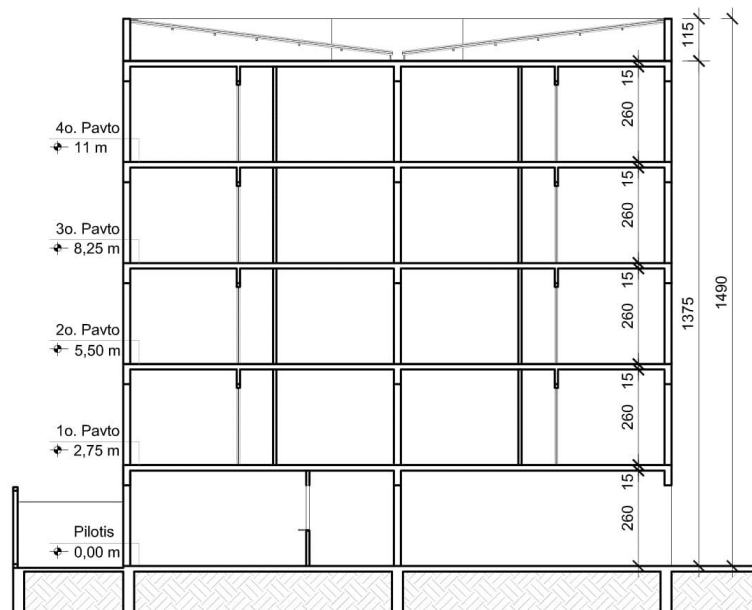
Planta Corte AA Cobertura Projeto 3
